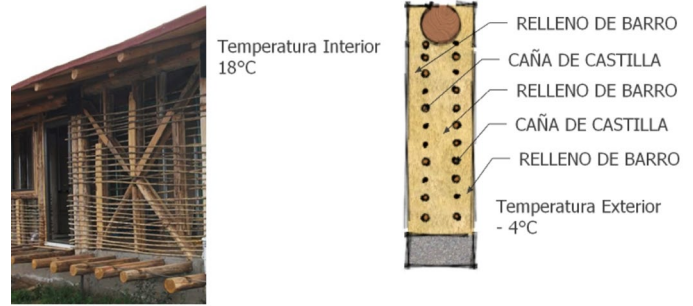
Salón de Usos Múltiples en etapa de construcción. Detalle de armado del muro de quincha. Fuente: Elaboración de los autores.
